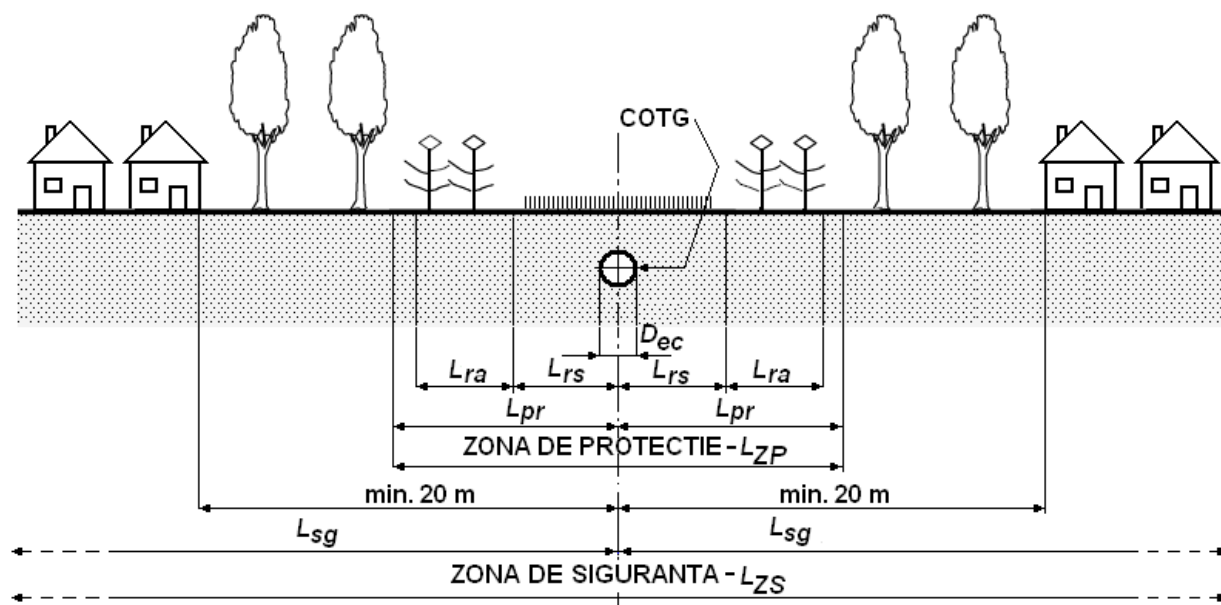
Planul zonelor de protecție și de siguranță ale unei COTG
